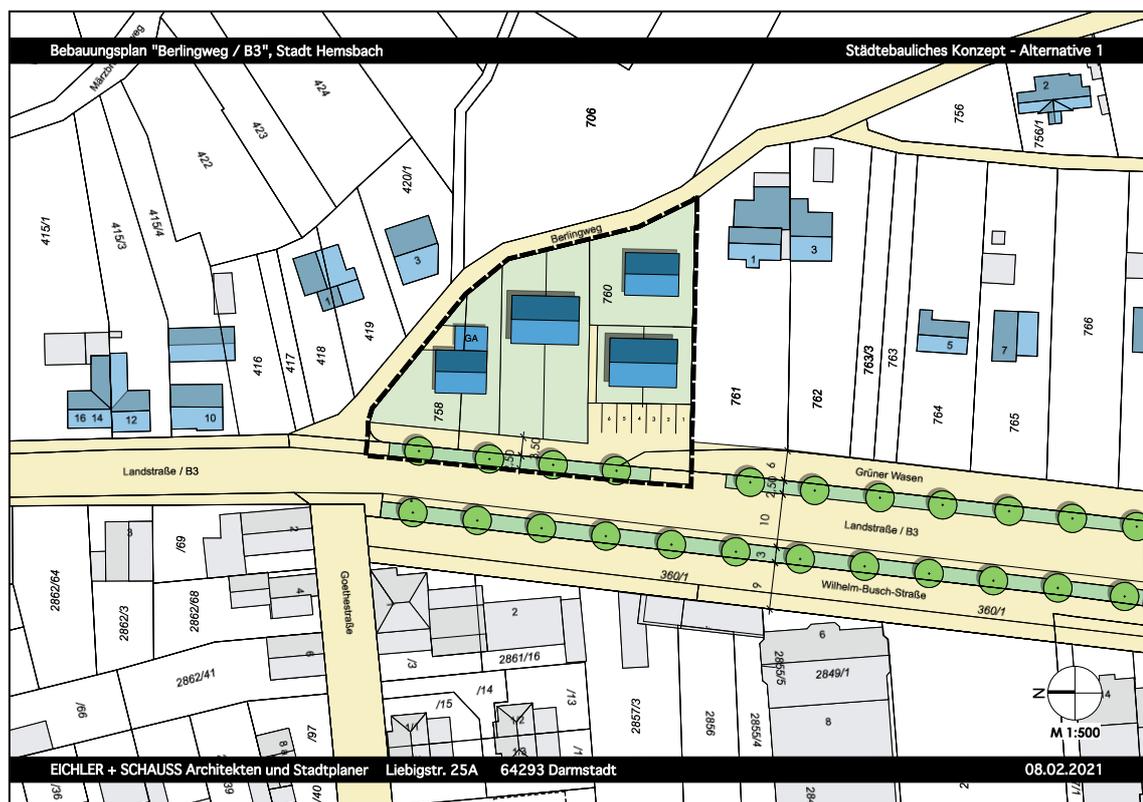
Städtebaulicher Entwurf Bebauungsplan 69 "Berlingweg - B 3", (ohne Maßstab), Stand 08.02.2021, Eichler + Schauss, Darmstadt
